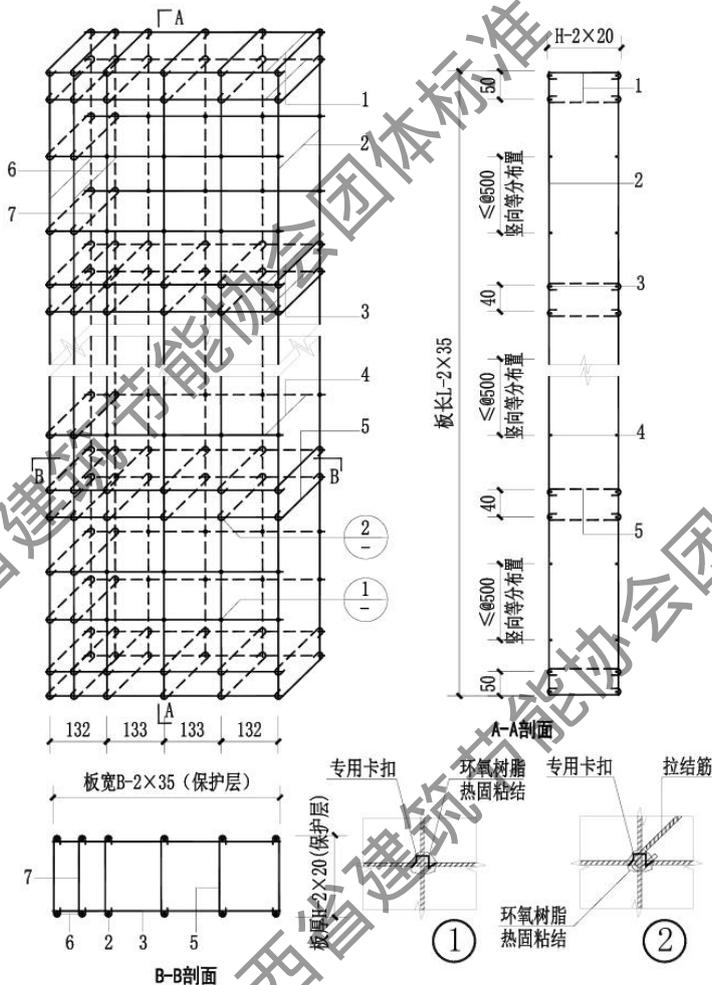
B 型板增强筋网笼构造示意图 (单位: mm)
